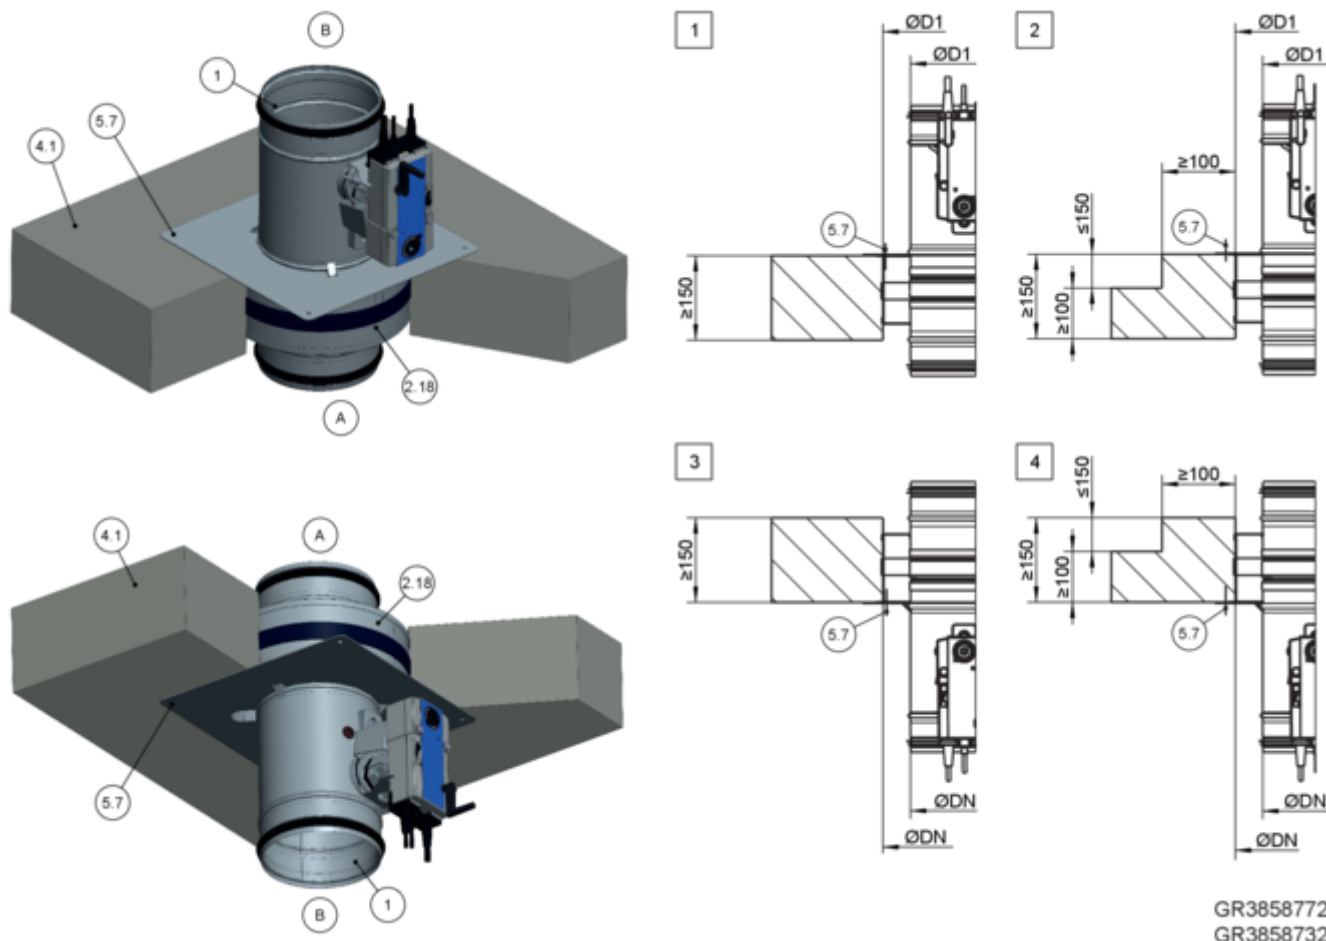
Installazione a secco senza malta con blocco di installazione ER in soffitti pieni a soletta, verticale o sospesa
